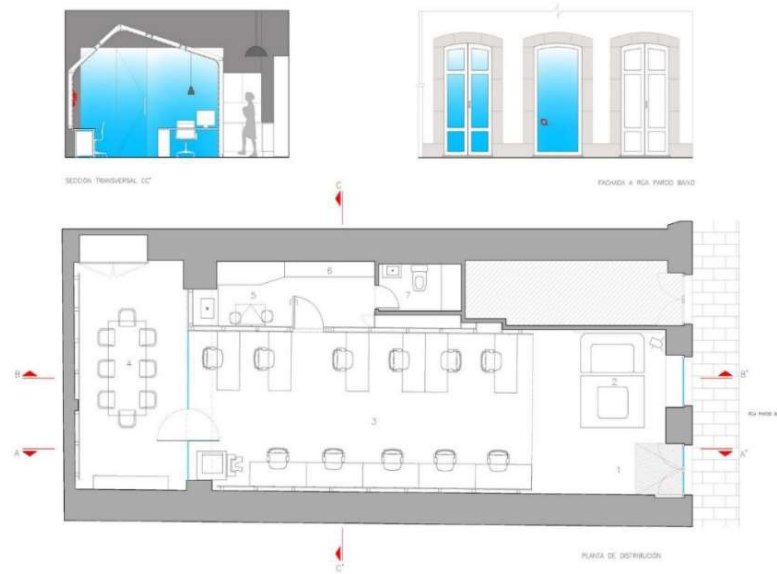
Planta, fachada y corte de AS-Built, imagen extraída de:
